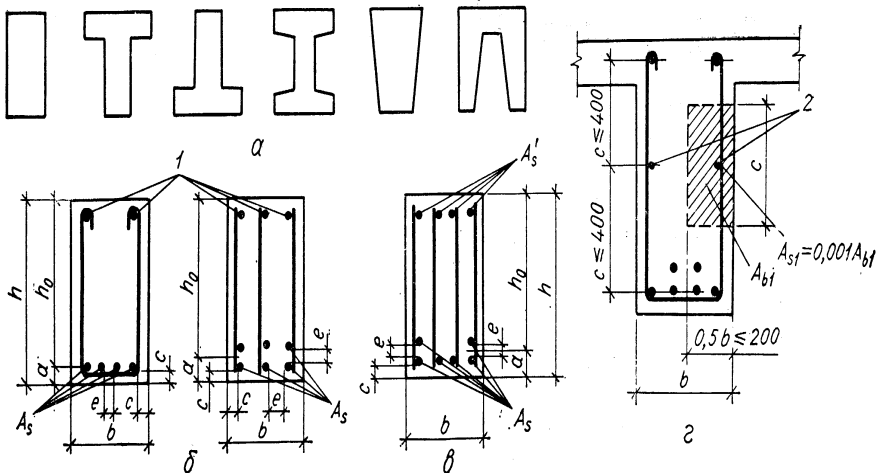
Форми поперечного перерізу залізобетонних балок та їх армування:
